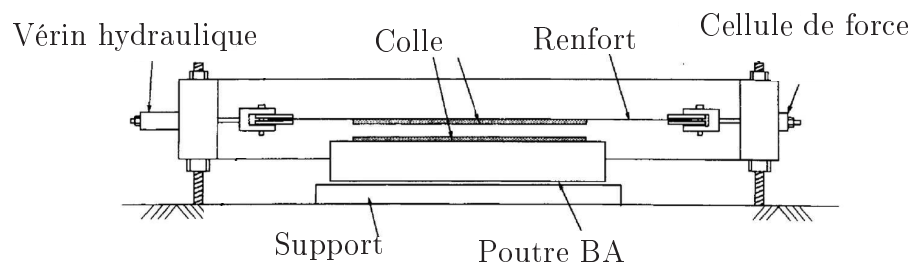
Système d'application de la précontrainte ([Garden et Hollaway, 1998](#))
